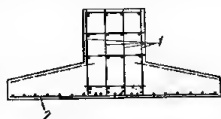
Схема армирования ленточного фундамента: 1 — сварные каркасы; 2 — сварные сетки.
